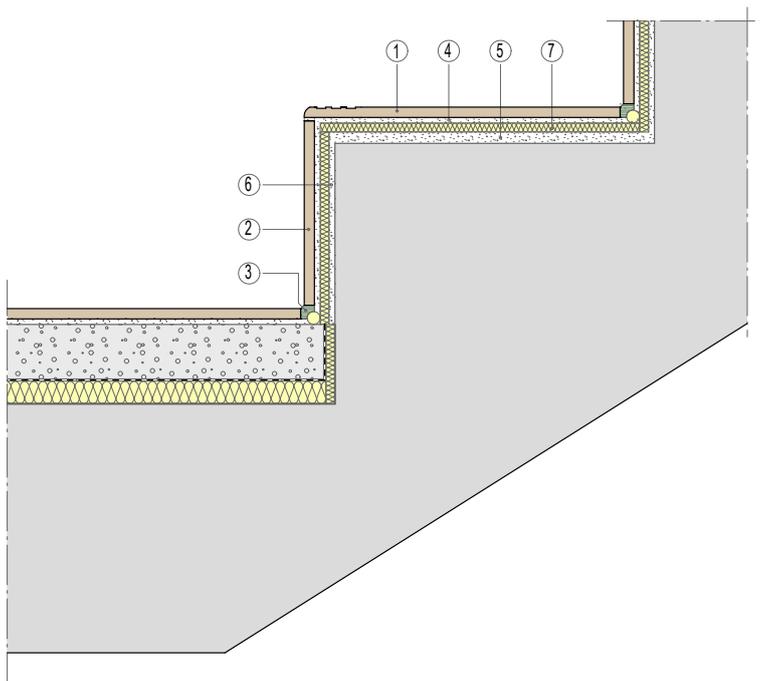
Ortbetontreppe mit trittschallgedämmten Stufen
